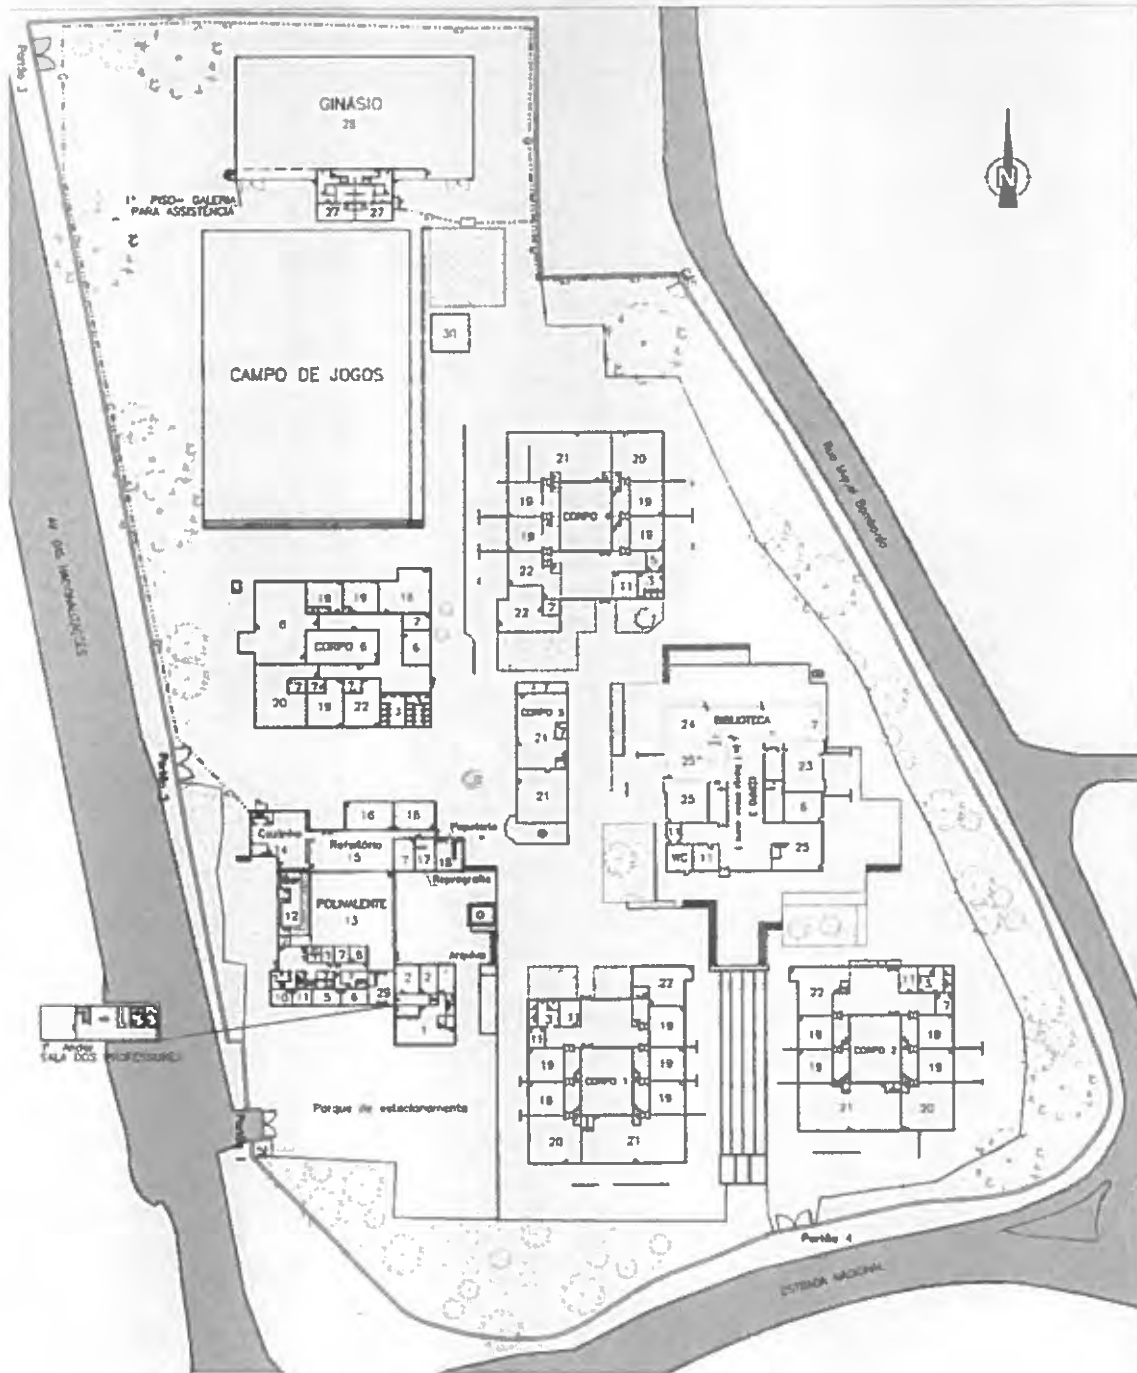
Planta Geral da Escola Álvaro Velho - Lavradio
